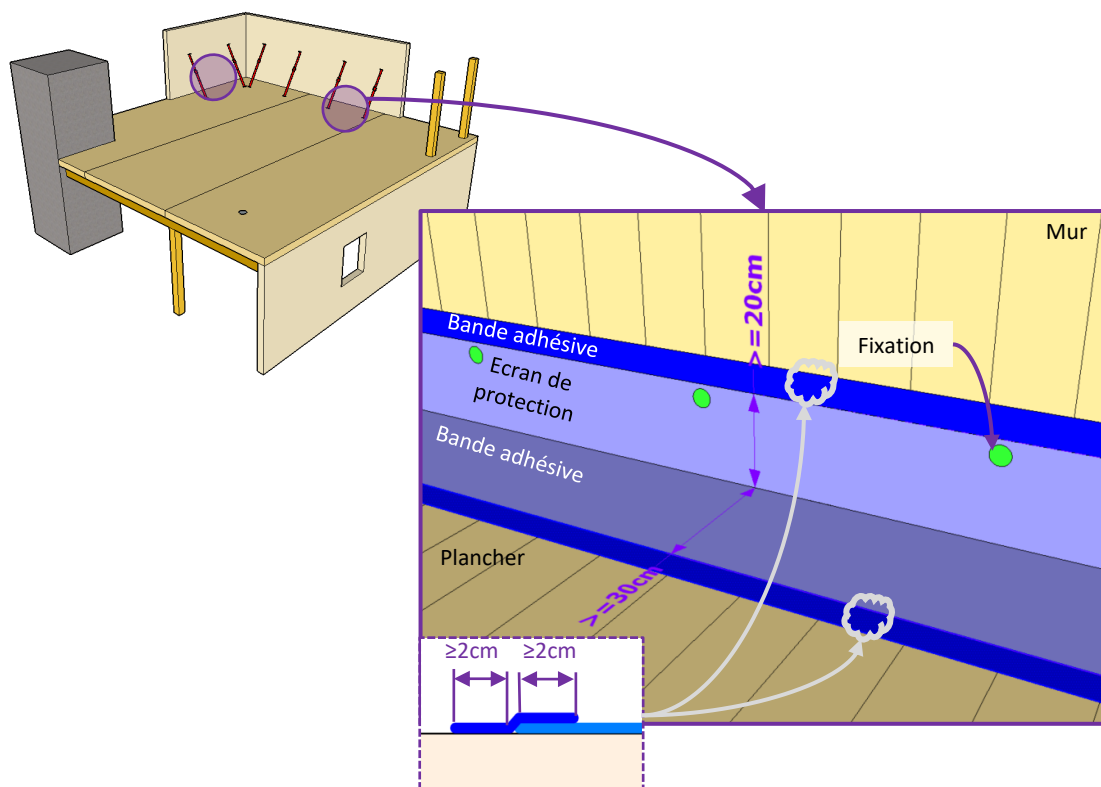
Représentation d'une protection à la jonction entre un plancher et des éléments verticaux
